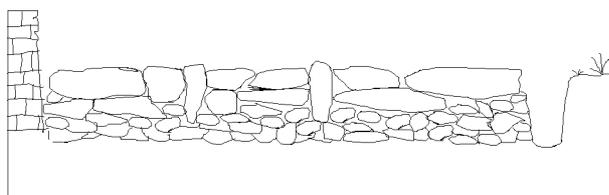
Perfil de la calzada en el lugar de Trasmonte.
